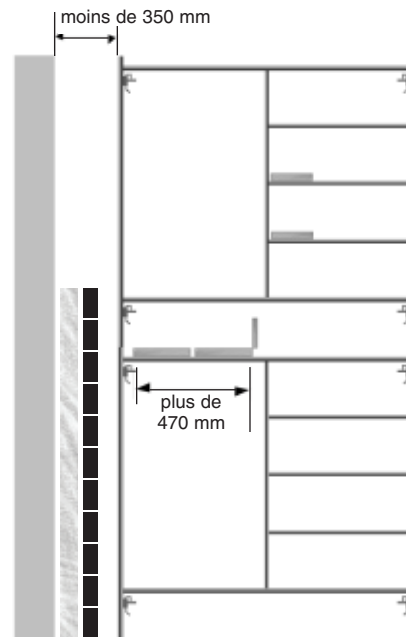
Largeur du plancher et sa distance p/r à la surface de travail
